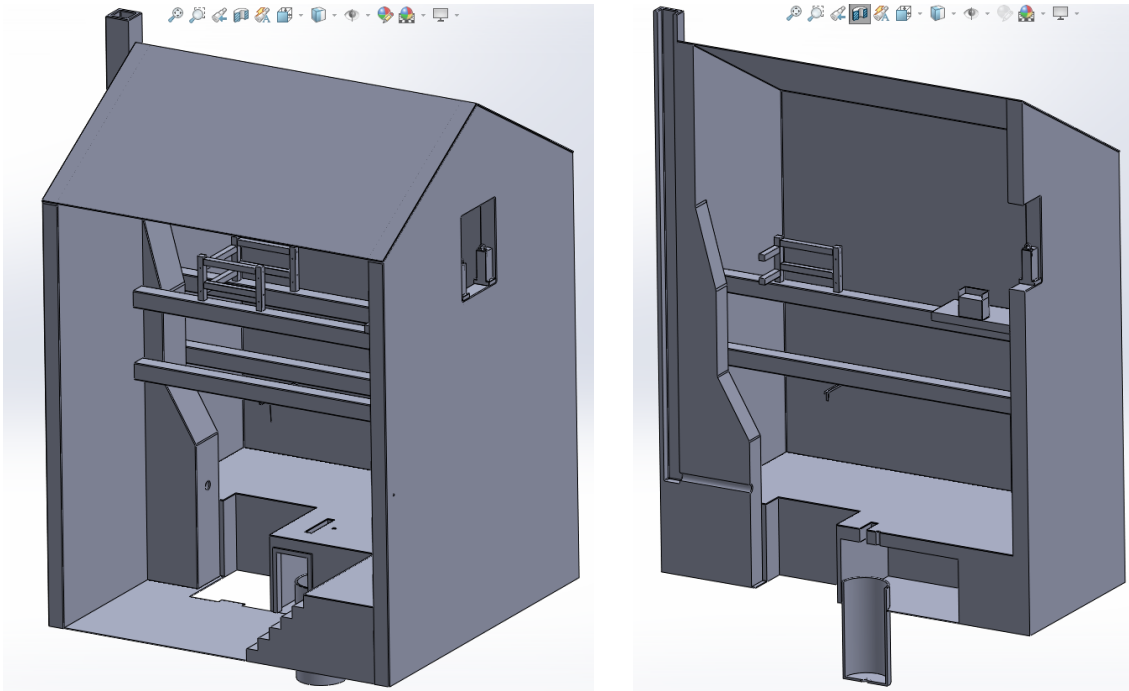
Sub-ensamblaje 01-03-00, respectivo al Edificio en el que se instala la máquina de vapor de Newcomen. Vista general completa (izquierda) y vista general de sección (derecha).
